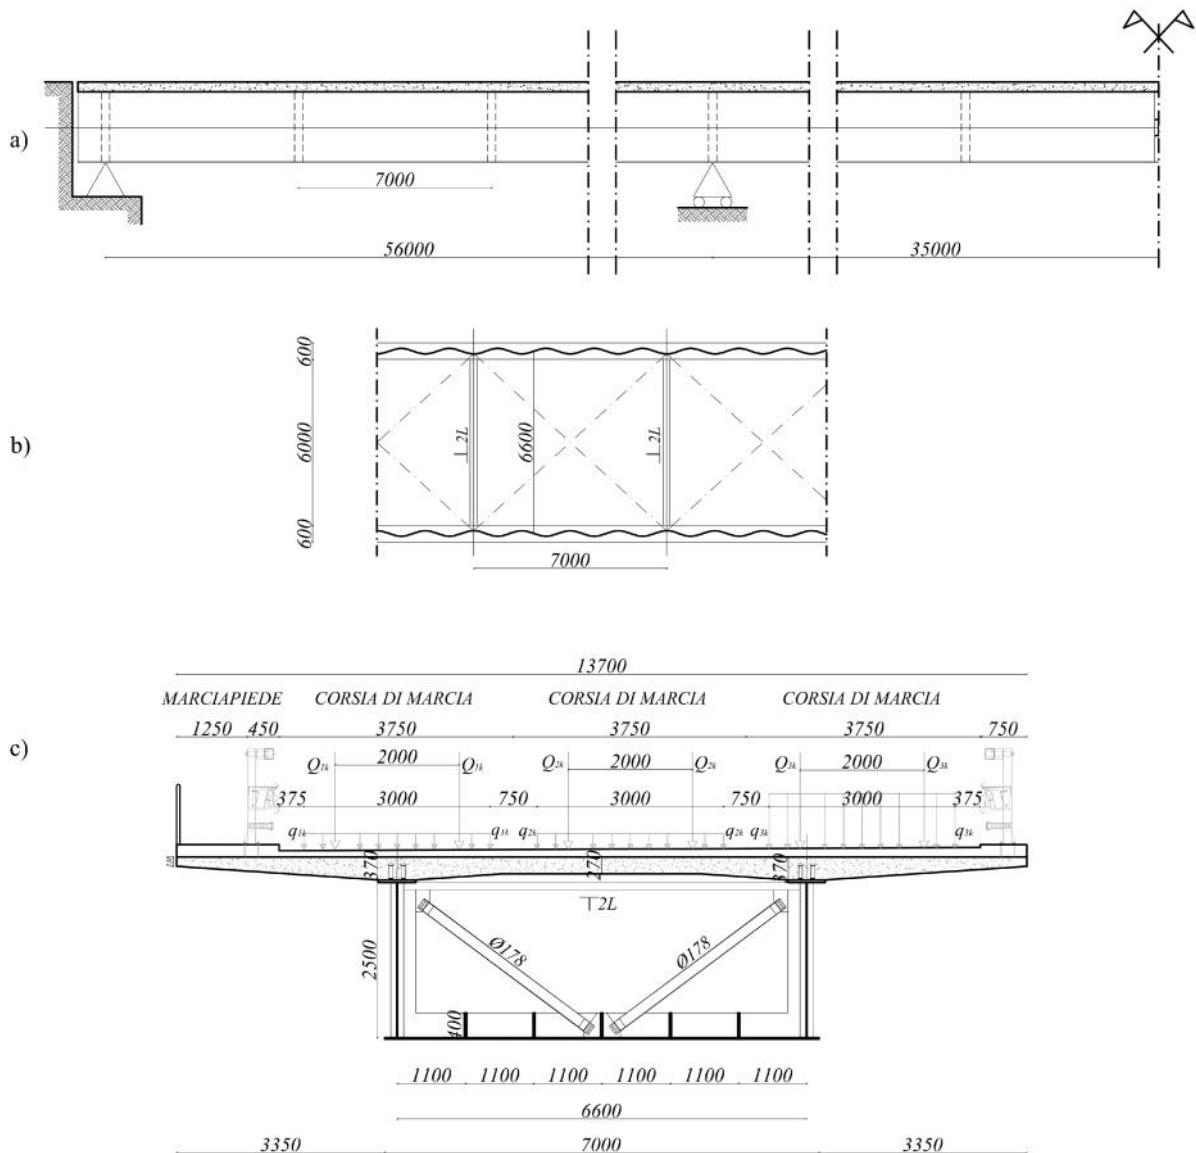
Impalcato misto: a) sezione longitudinale b) controventatura superiore c) sezione trasversale
